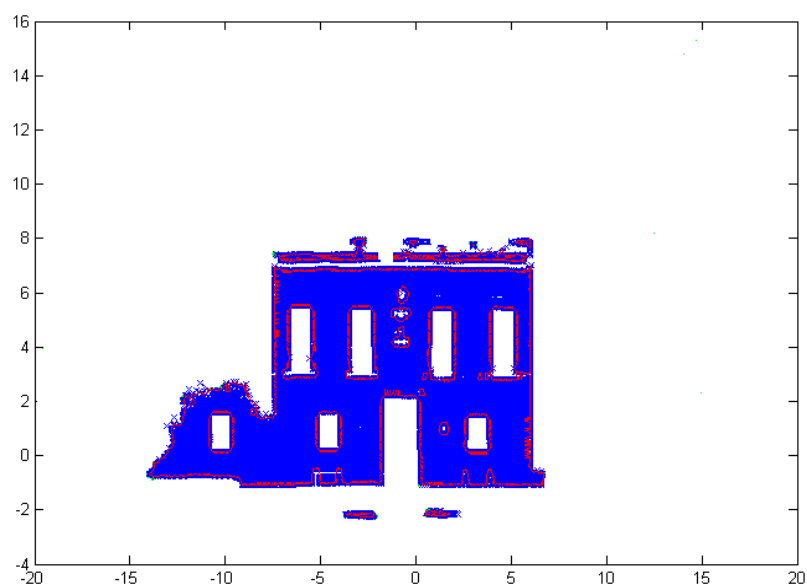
TRIANGULAÇÃO DE DELAUNAY – PAREDE CENTRAL DA FACHADA
